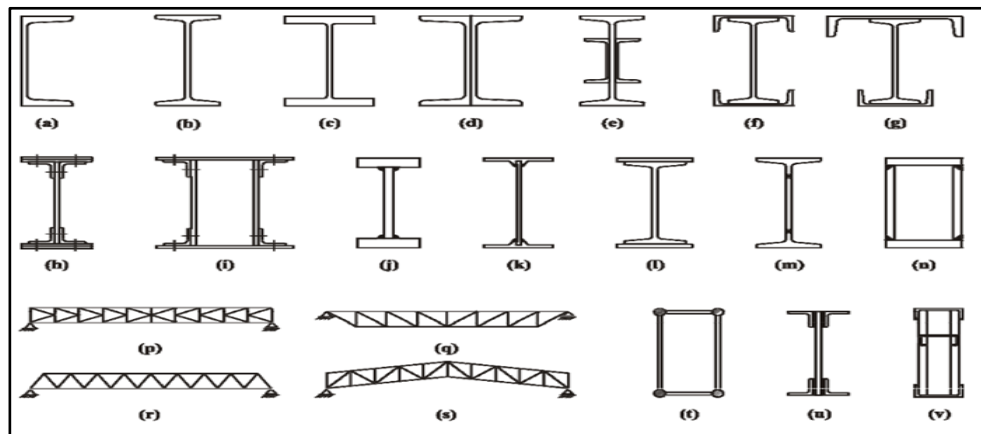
Vigas de alma llena (Narciso, s.f, Construcciones Metálicas).
